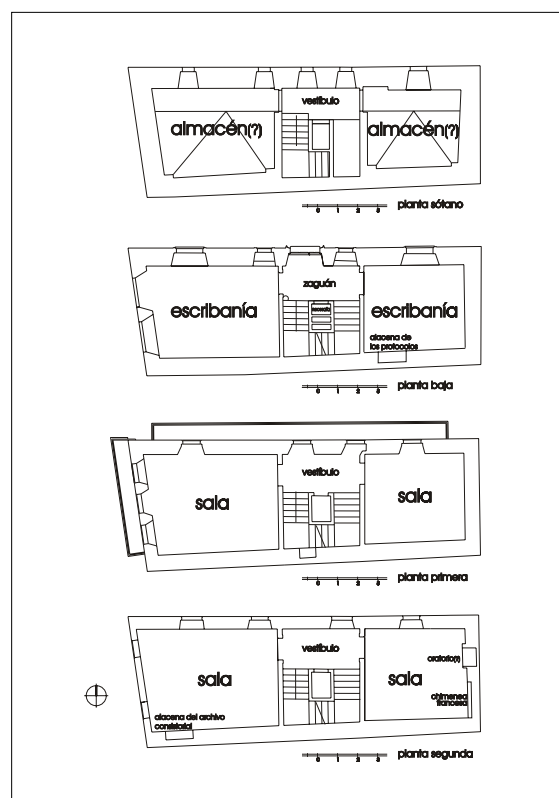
Reconstrucción hipotética de la distribución interior original a partir de planimetrías (trabajo infomático de Luis Faraón).
